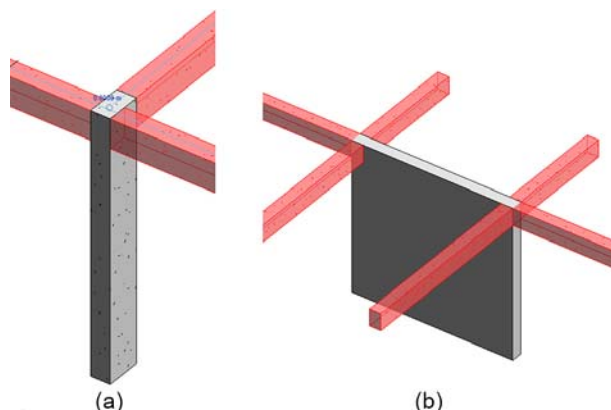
Interação entre (a) pilares e vigas e (b) paredes e vigas
